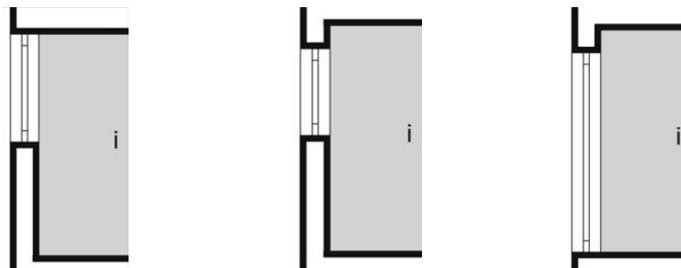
Relevante Brüstungs- und Sturztypen mit Schwellenwerten gemäss Abbildung 30 hinsichtlich der Lüftungsverteilung (links: nur Brüstung ohne Sturz, mittig: Brüstung und Sturz, rechts: nur Sturz ohne Brüstung)
